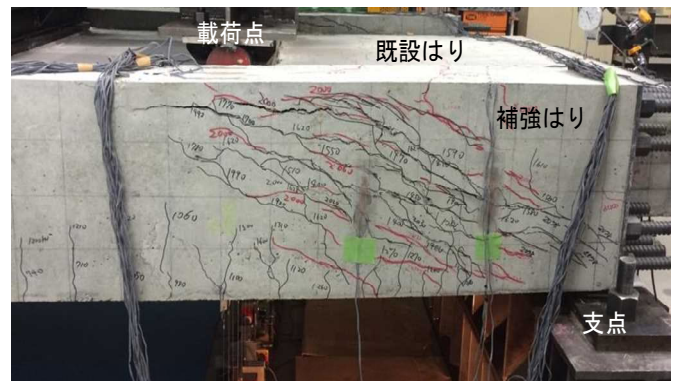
No.3 試験体の最大荷重直後のひび割れ性状
